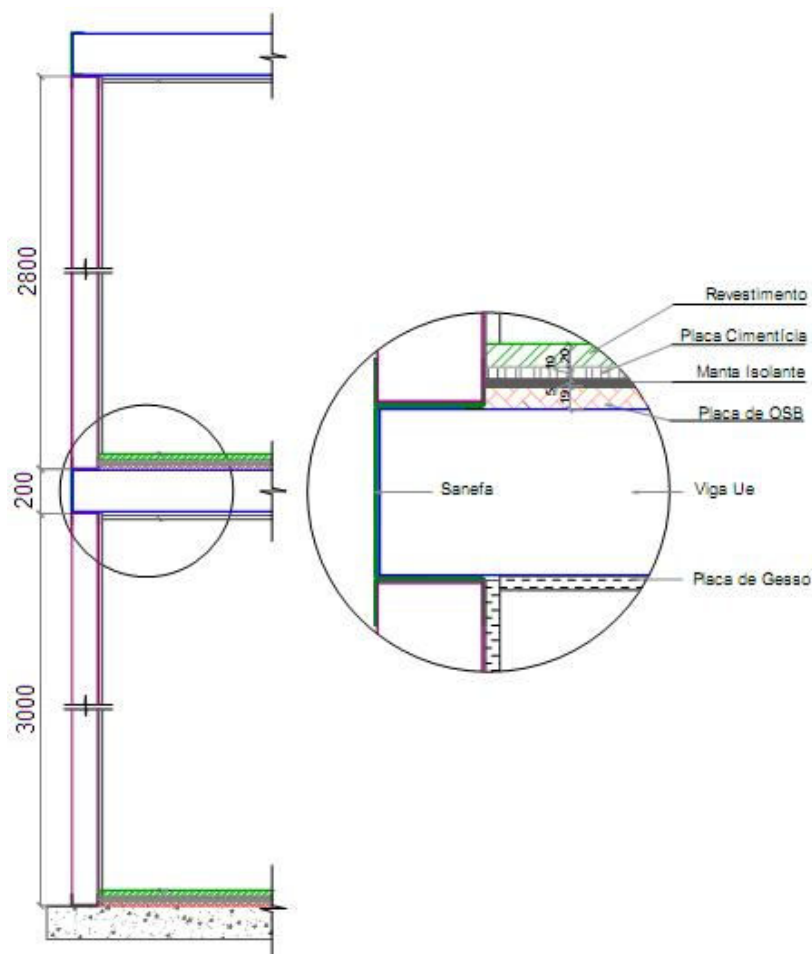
Laje Seca utilizada no segundo pavimento.
